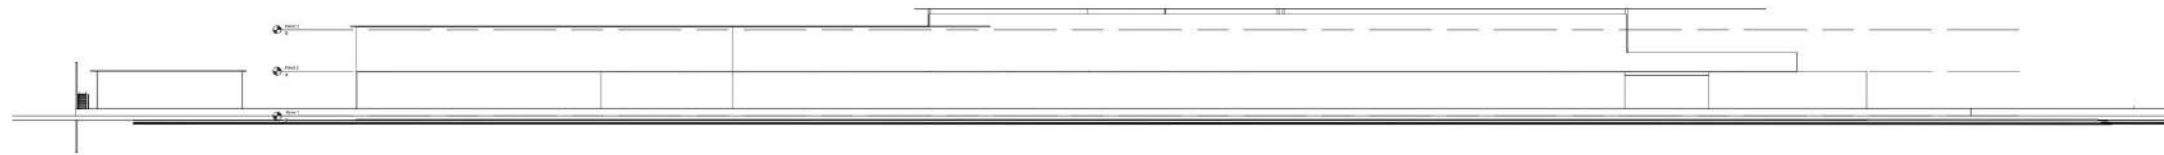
[PLANTA DE ESTACIONAMIENTO](#)
